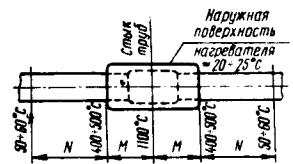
Зоны распределения температур по трубе при пайке соединений трубопроводов.
